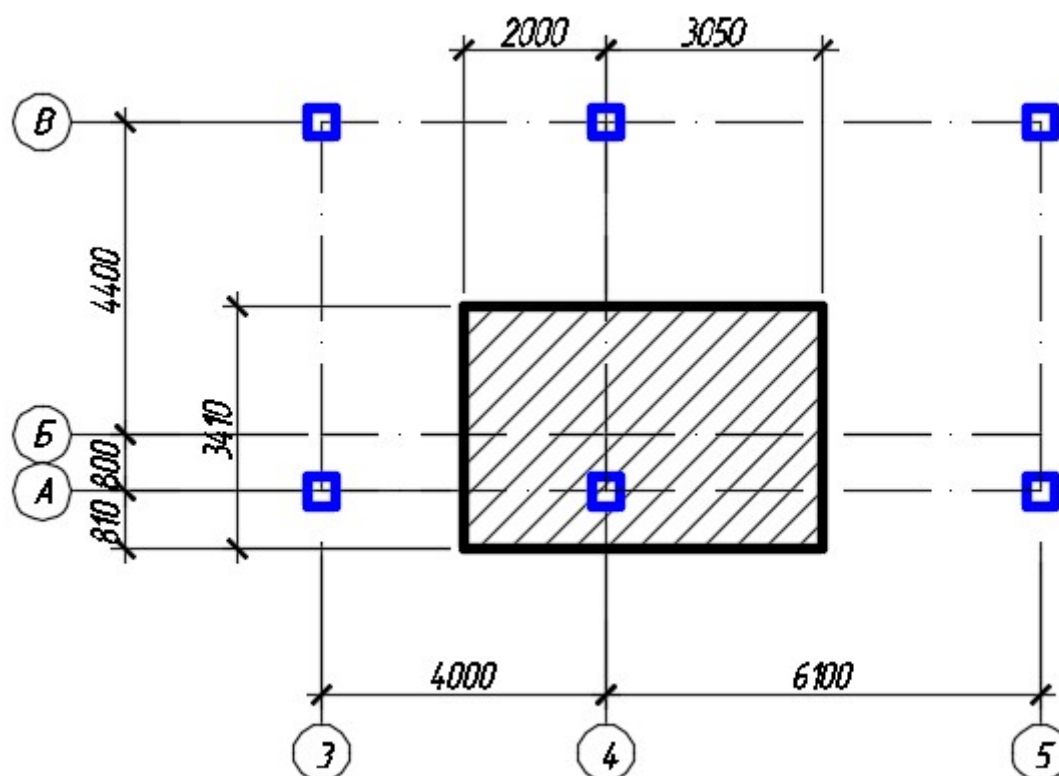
Грузовая площадь на фундамент в осях 4-А
